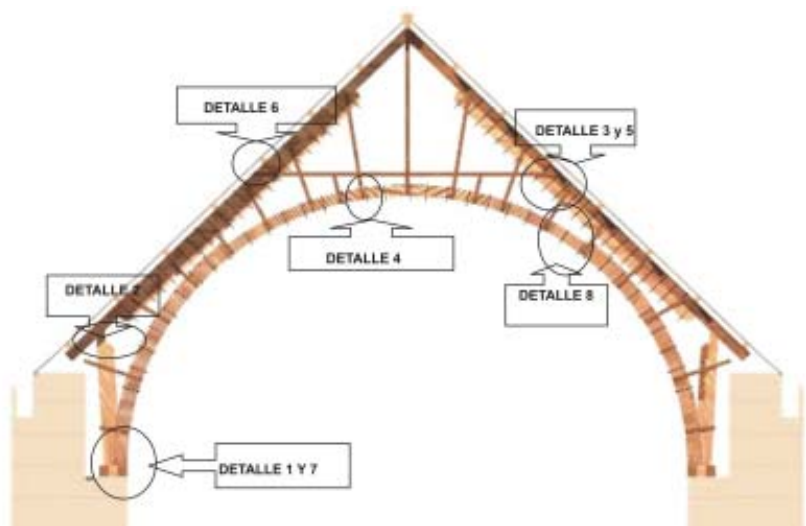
DETALLES CONSTRUCTIVOS (DIBUJO DEL AUTOR)
